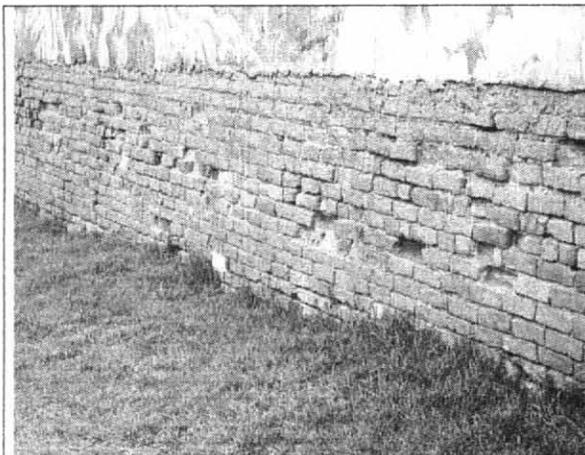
Rotura significativa de piezas de mampostería a lo largo del muro en su parte inferior.
